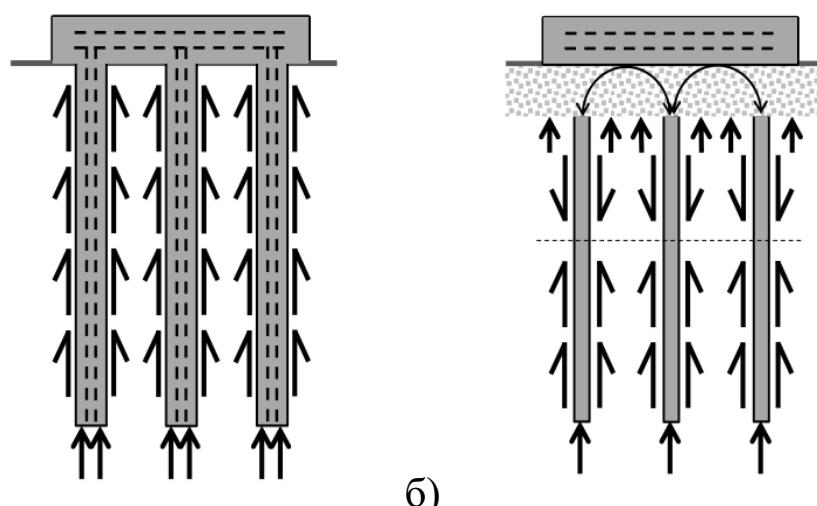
а) Пальовий фундамент; б) Фундамент з вертикально-армованими елементами.
